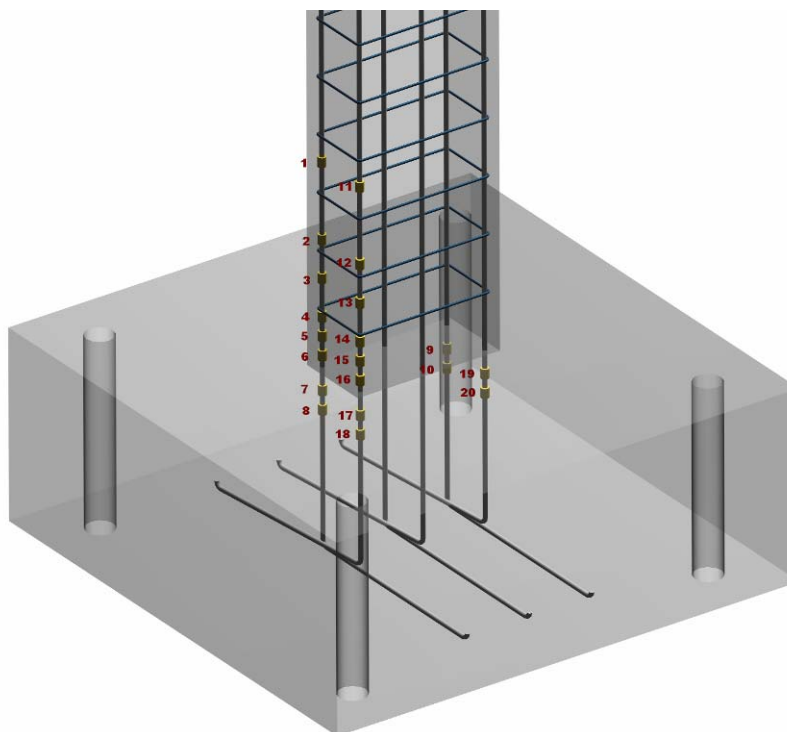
Instrumentação da armadura longitudinal dos modelos PA1 (Perspectiva).
